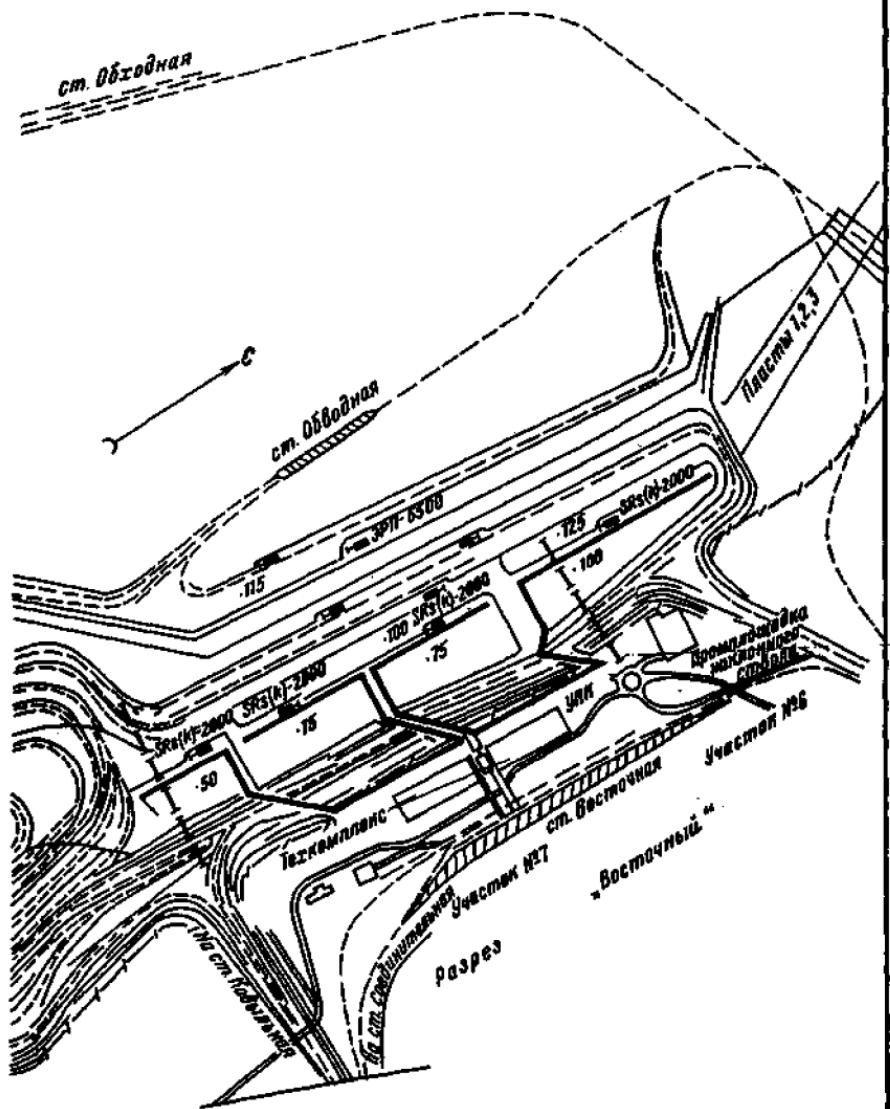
Схема горных работ разрезов южной группы на втором этапе реконструкции
